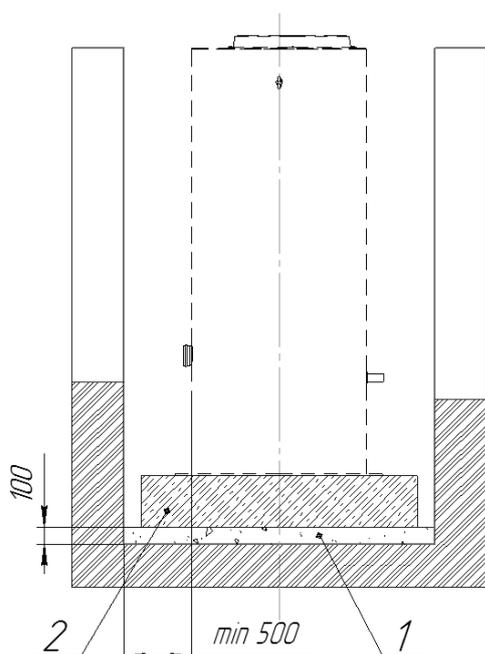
Организация котлована и заливка железобетонной плиты
